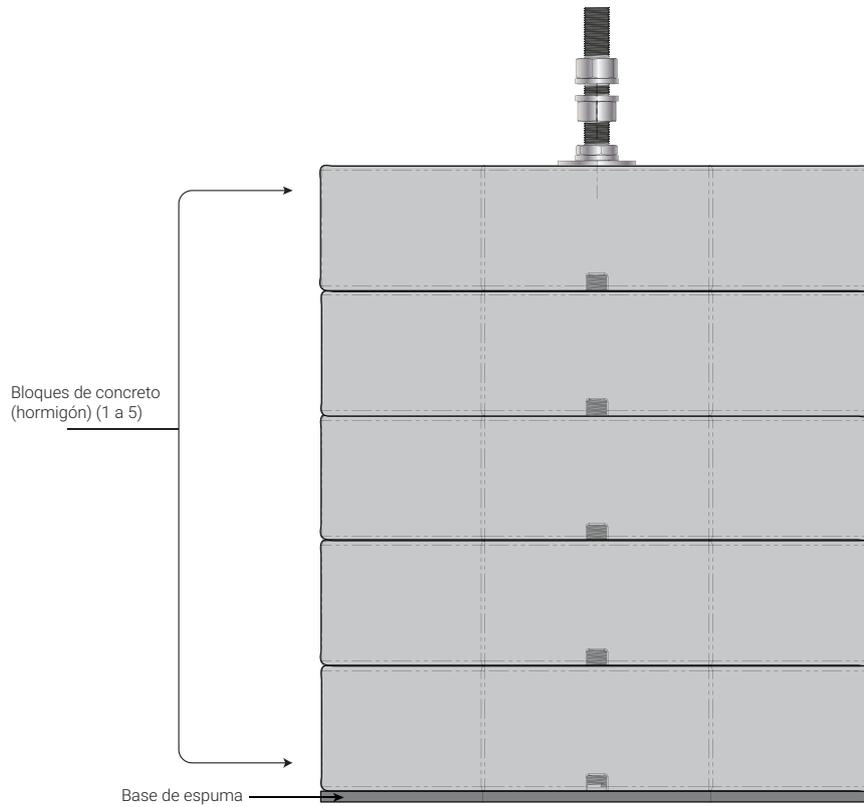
Pila de bloques de concreto (hormigón) para soporte de mástil en una ubicación horizontal
